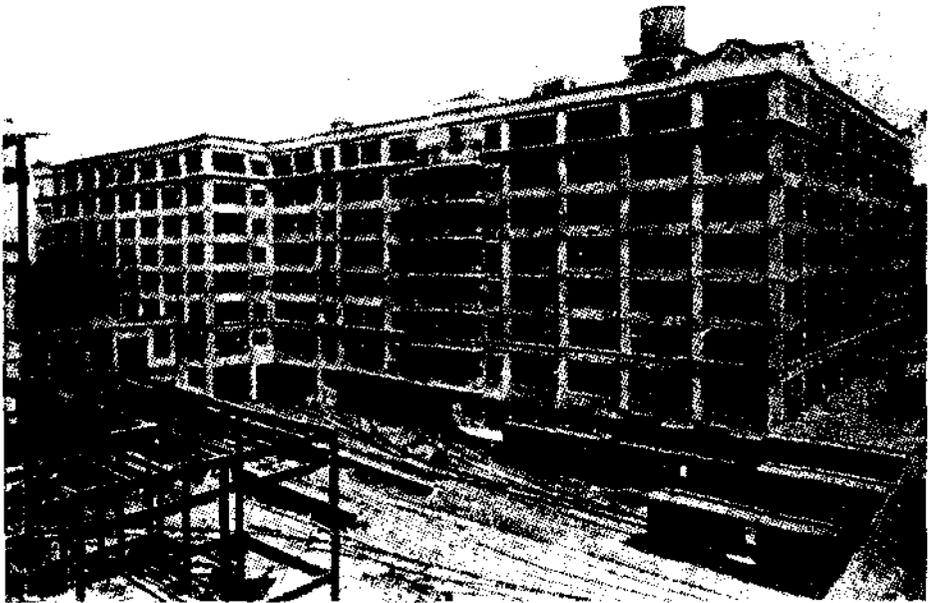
Стадия постройки железобетонного фабричного здания.
